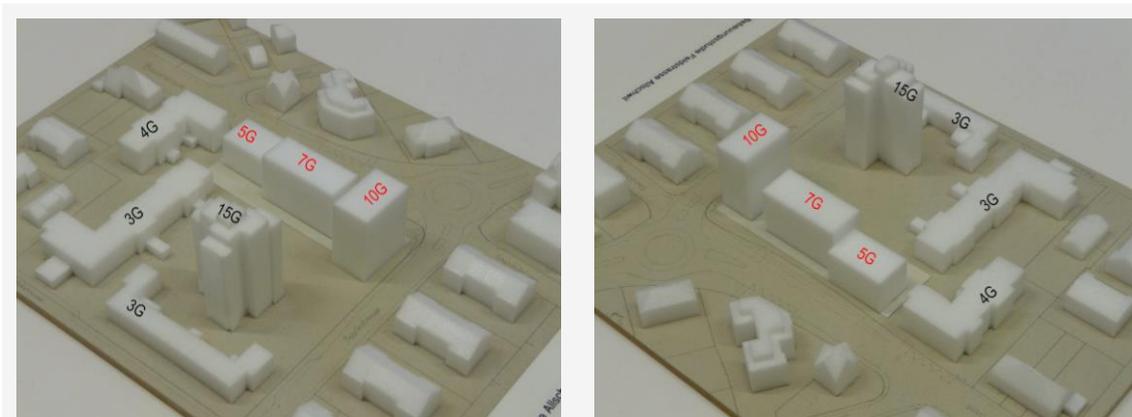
Bebauungsvariante 4a, Bebauungsstudie Baslerstrasse 160 – 166 vom 14.03.2016
